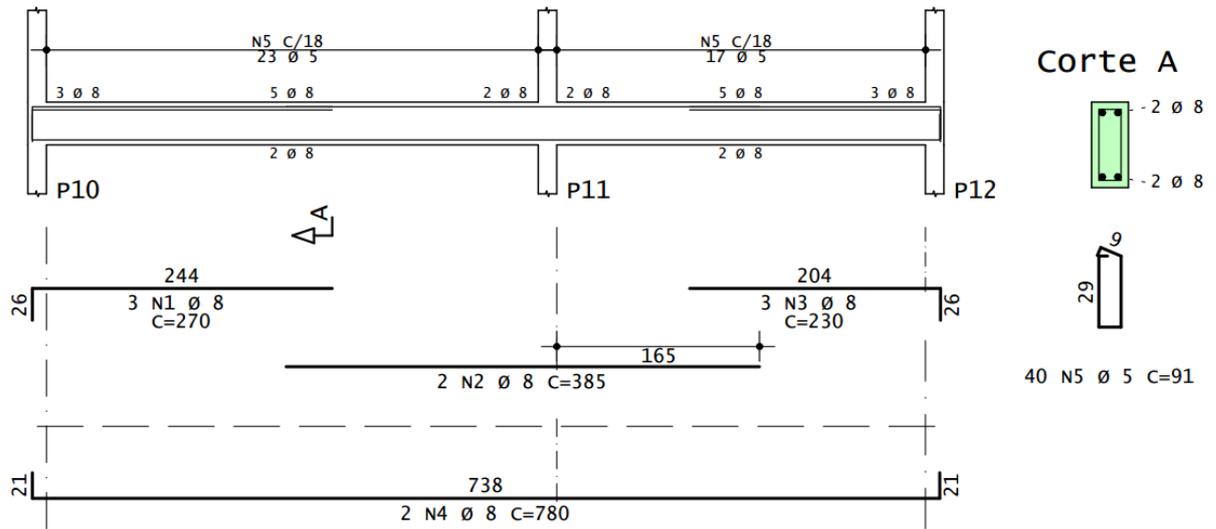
Armadura da viga baldrame V8 – pavimento térreo (nível 0,00)
